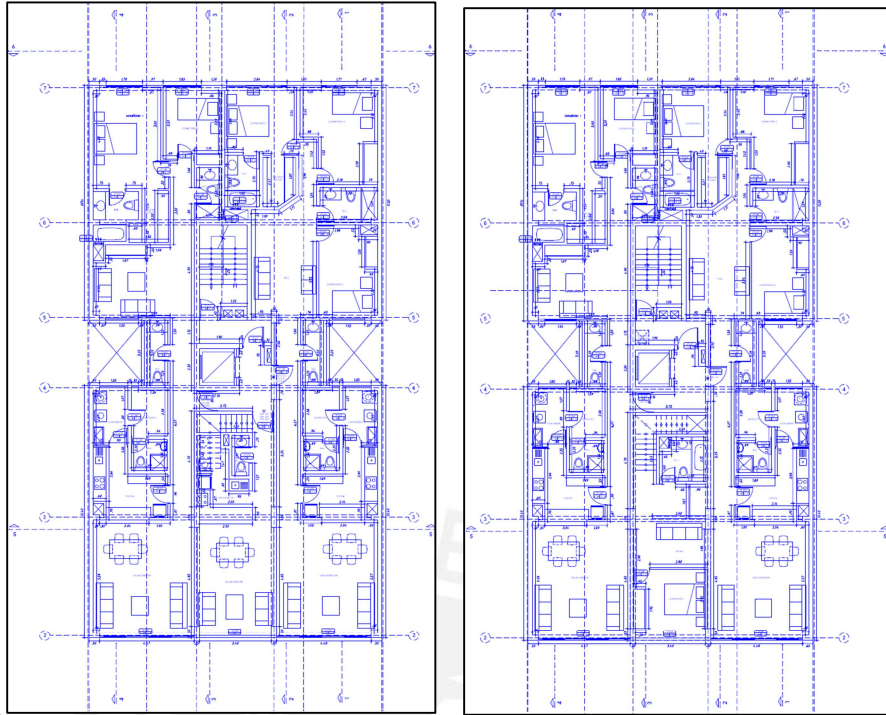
y 1.3. Vistas en planta de pisos típicos del proyecto
